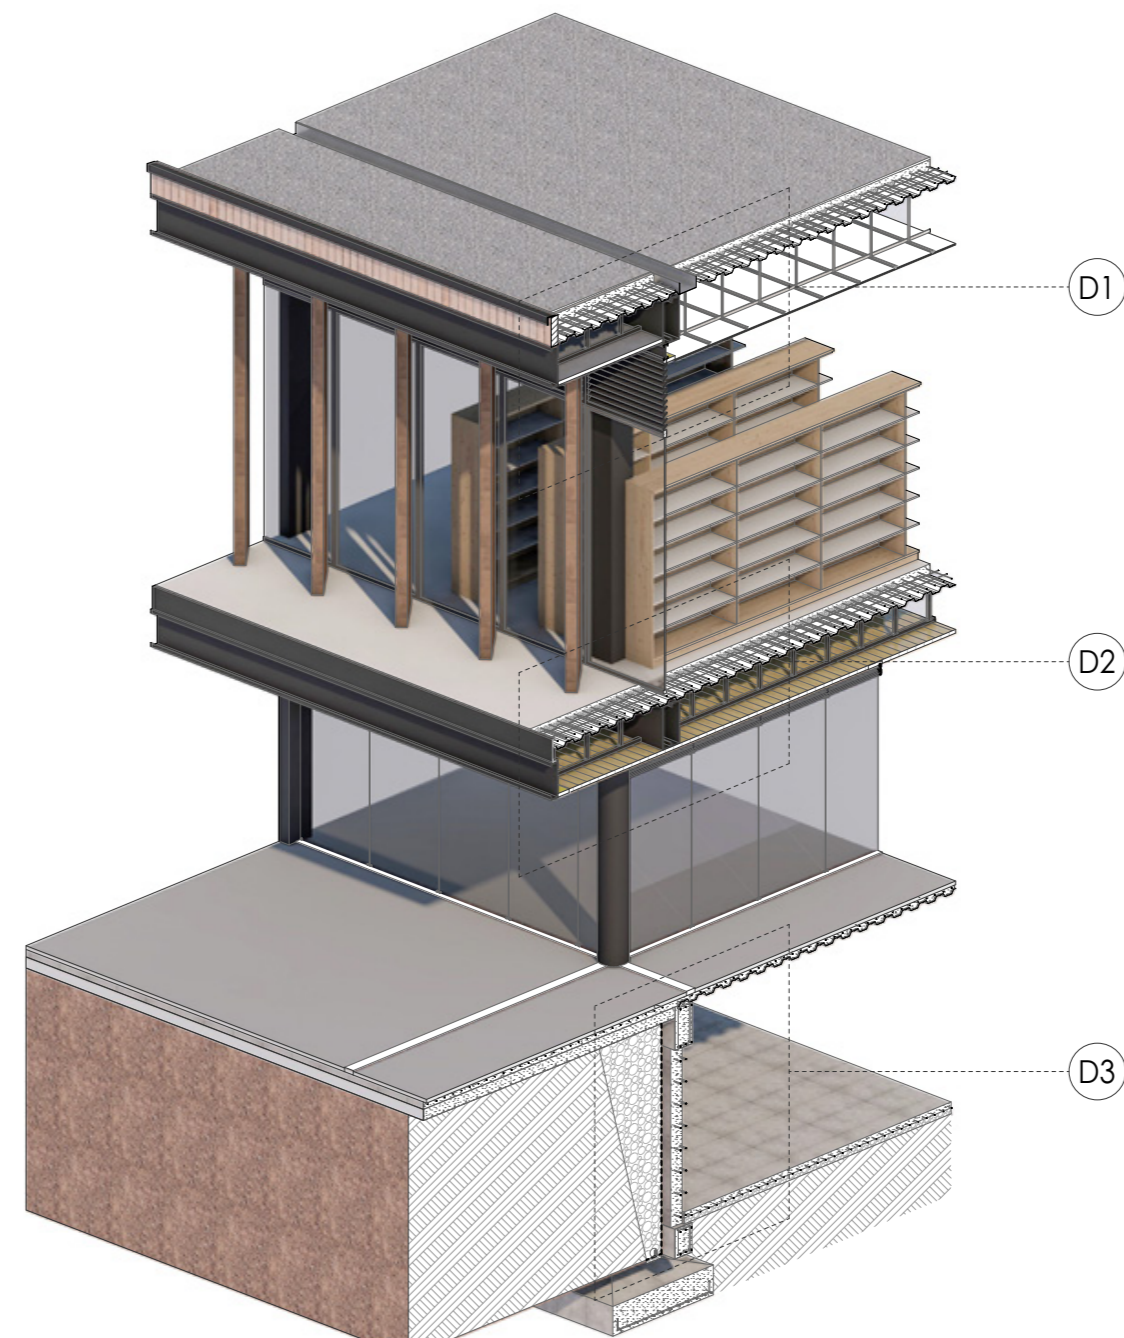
Sección constructiva Biblioteca | Fuente: Elaboración propia
